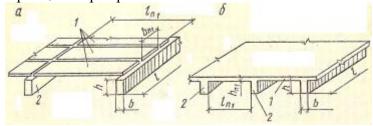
Схемы перекрытий из железобетонных элементов: a- сборное; b- монолитное; b- плиты; b- балки.
